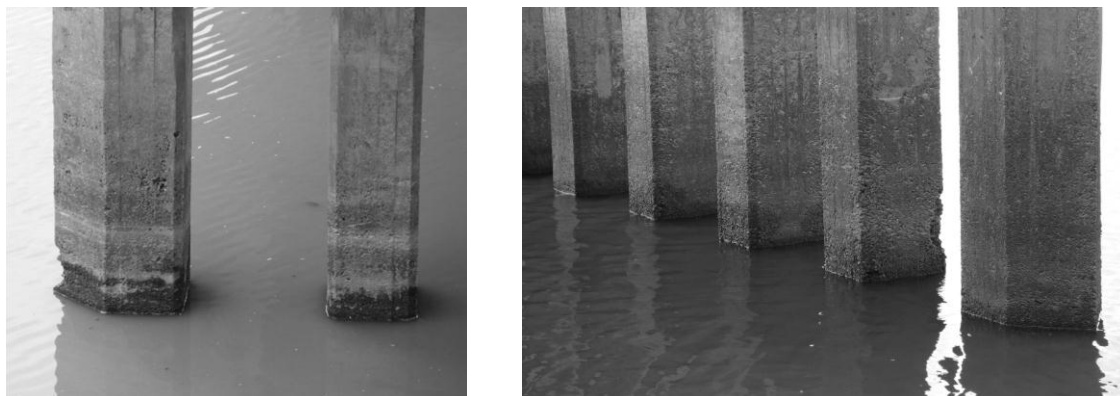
Pilas – pilote con (a) Pérdida de concreto, desgaste. (b) Humedecimiento - secado,
